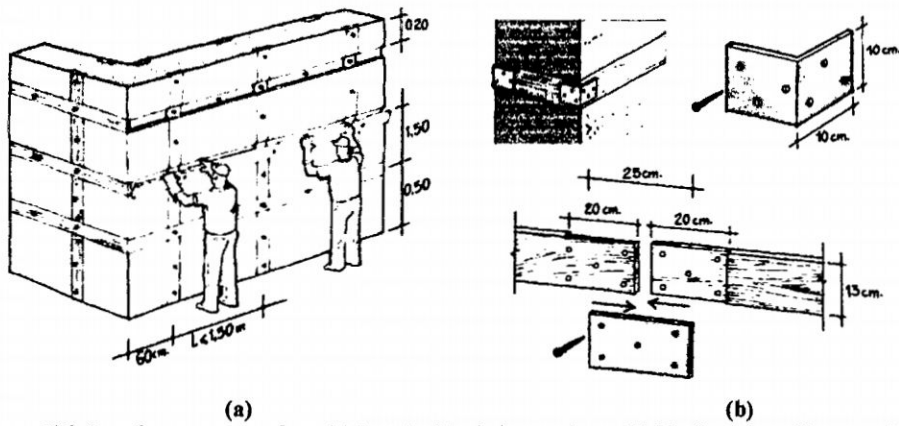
refuerzo con madera (a) Instalación de las maderas (b) Platinas de unión y traslapes
